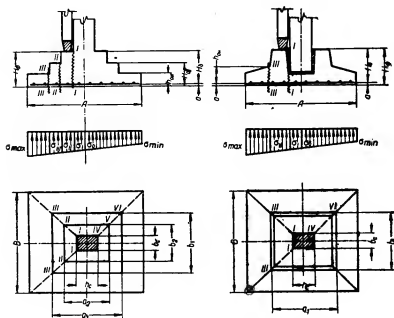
142. Расчетные схемы внецентренно нагруженных фундаментов:
